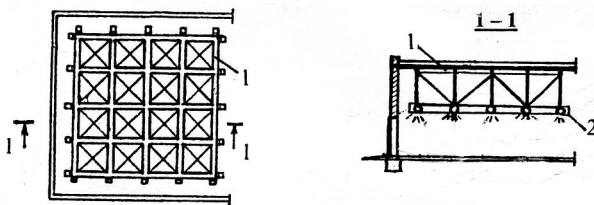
Структурная ферма покрытия, совмещенная со световодами
